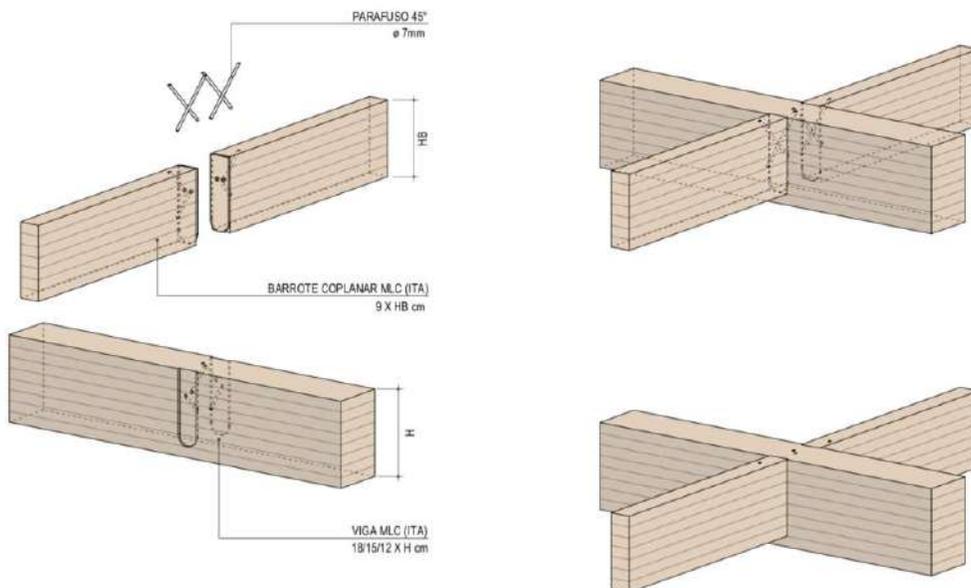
Detalhamento construtivo da fixação do barrote com cauda de andorinha. (fonte: Ita Construtora)
